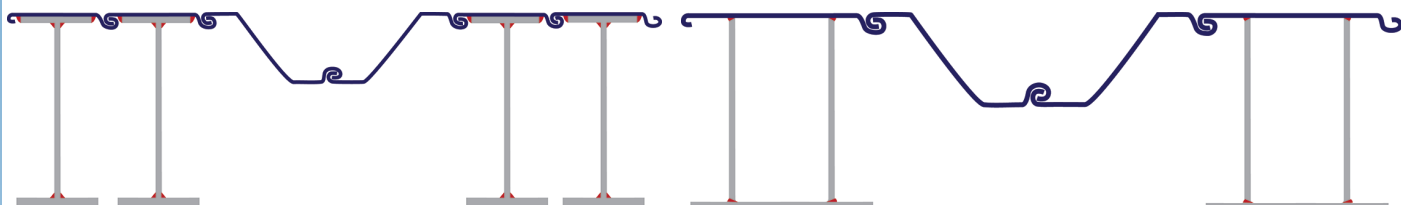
Несущая свая в виде сварной разнополочной и разнотолщинной сдвоенной балки с х/к ПФЗ
